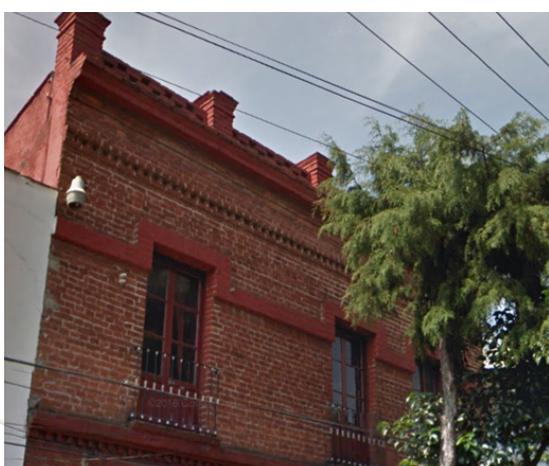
Muro con aparejo inglés, ubicado en la calle Merced Gómez. Fotografía del autor.
